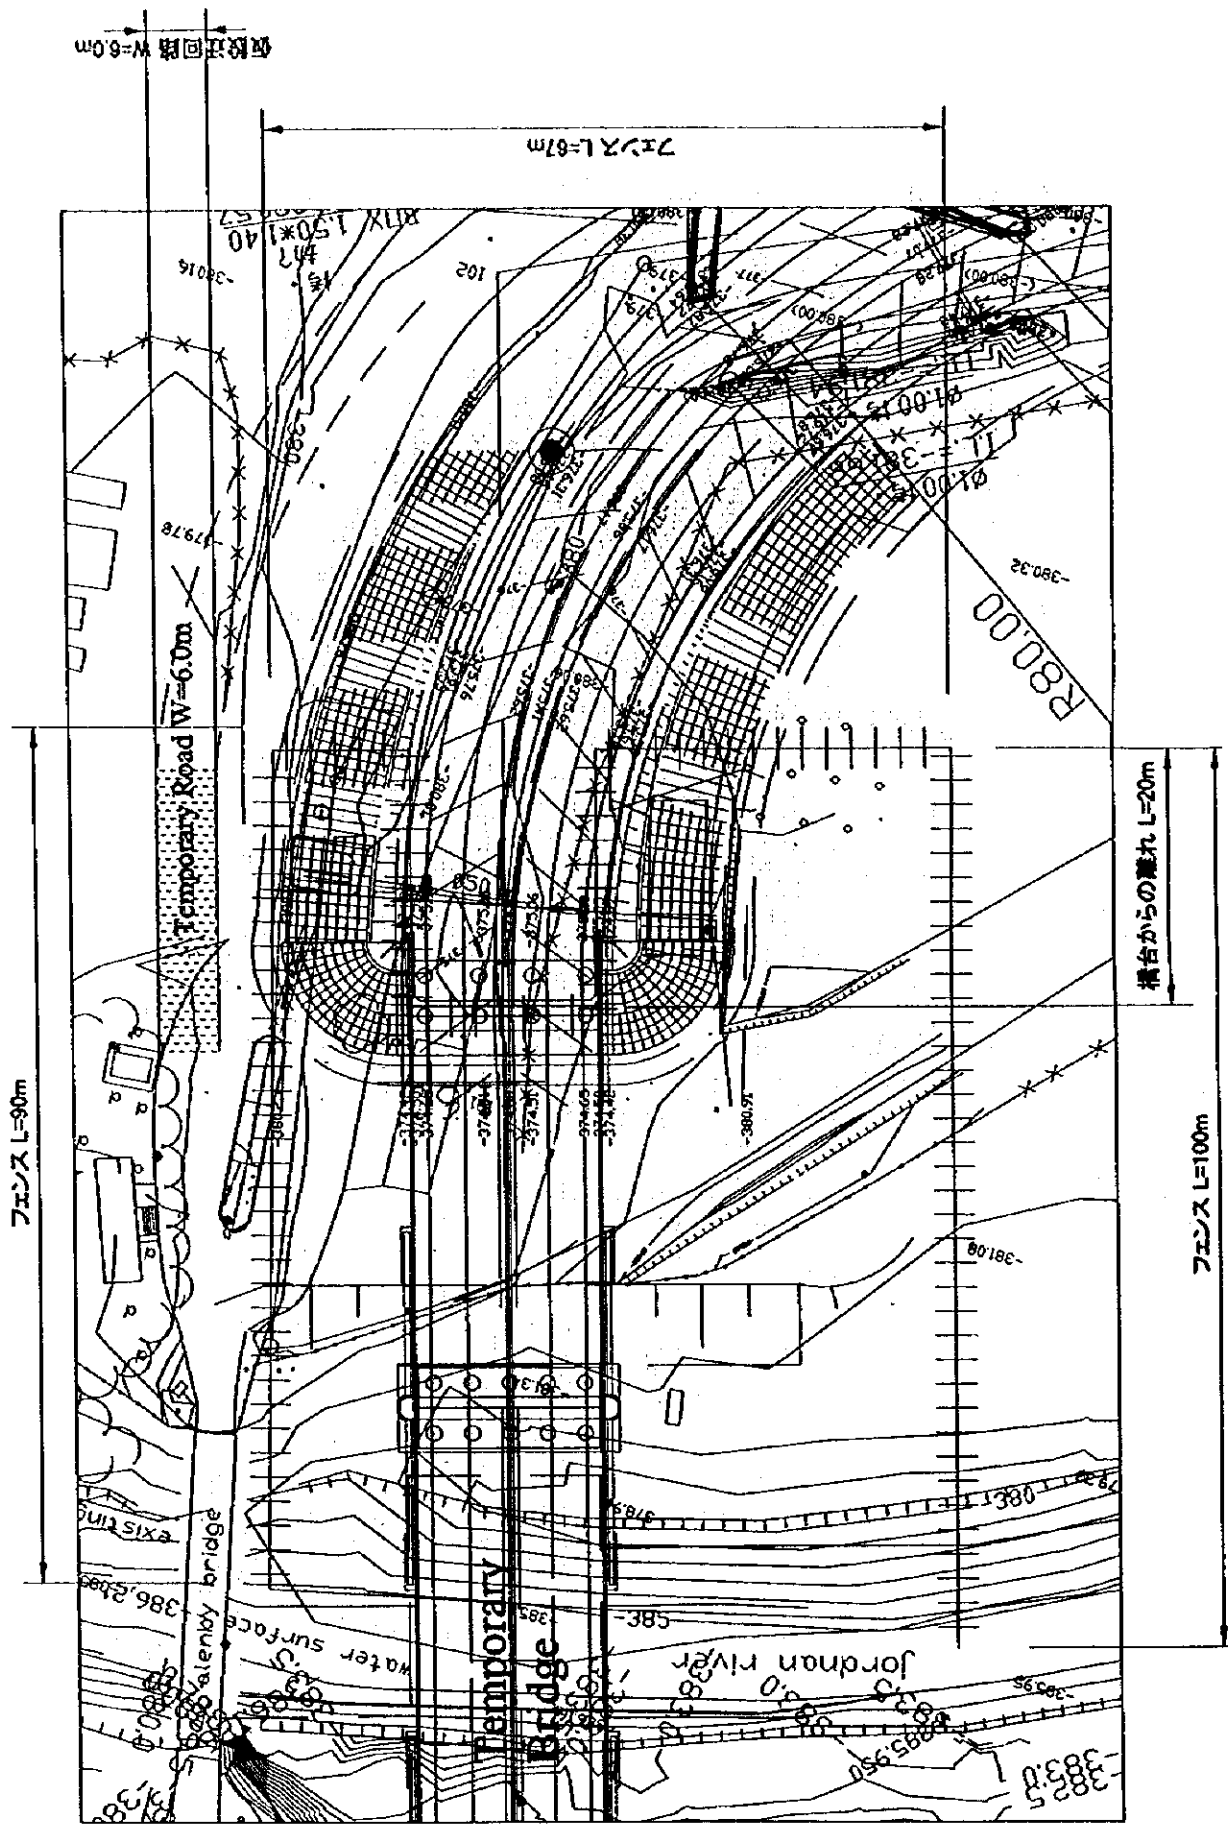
舗装施工時のフェンス及び迂回路位置図
